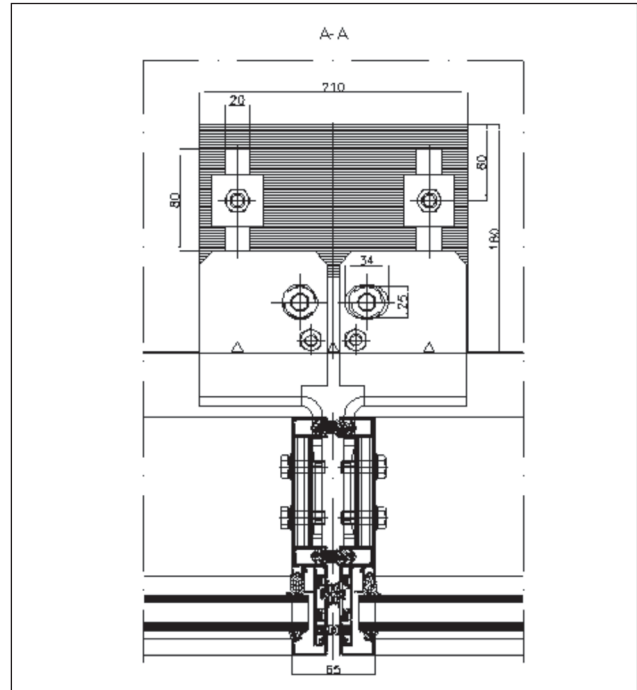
Fassadenkopplung nach dem Zusammenfügen – Horizontalschnitt
